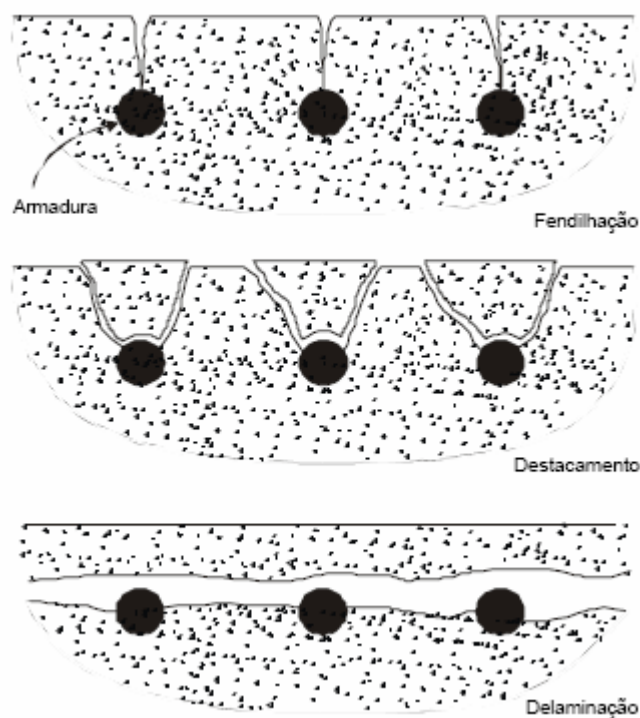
Deterioração do concreto causada pela corrosão das armaduras (FERREIRA, 2000).
